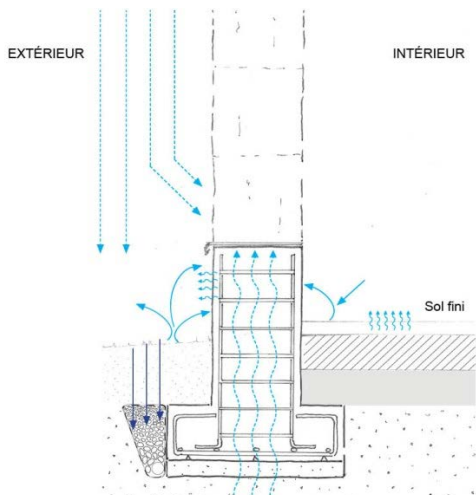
Fondation soubassement\* BA, sol en terre enherbée, drain\* le long des fondations
